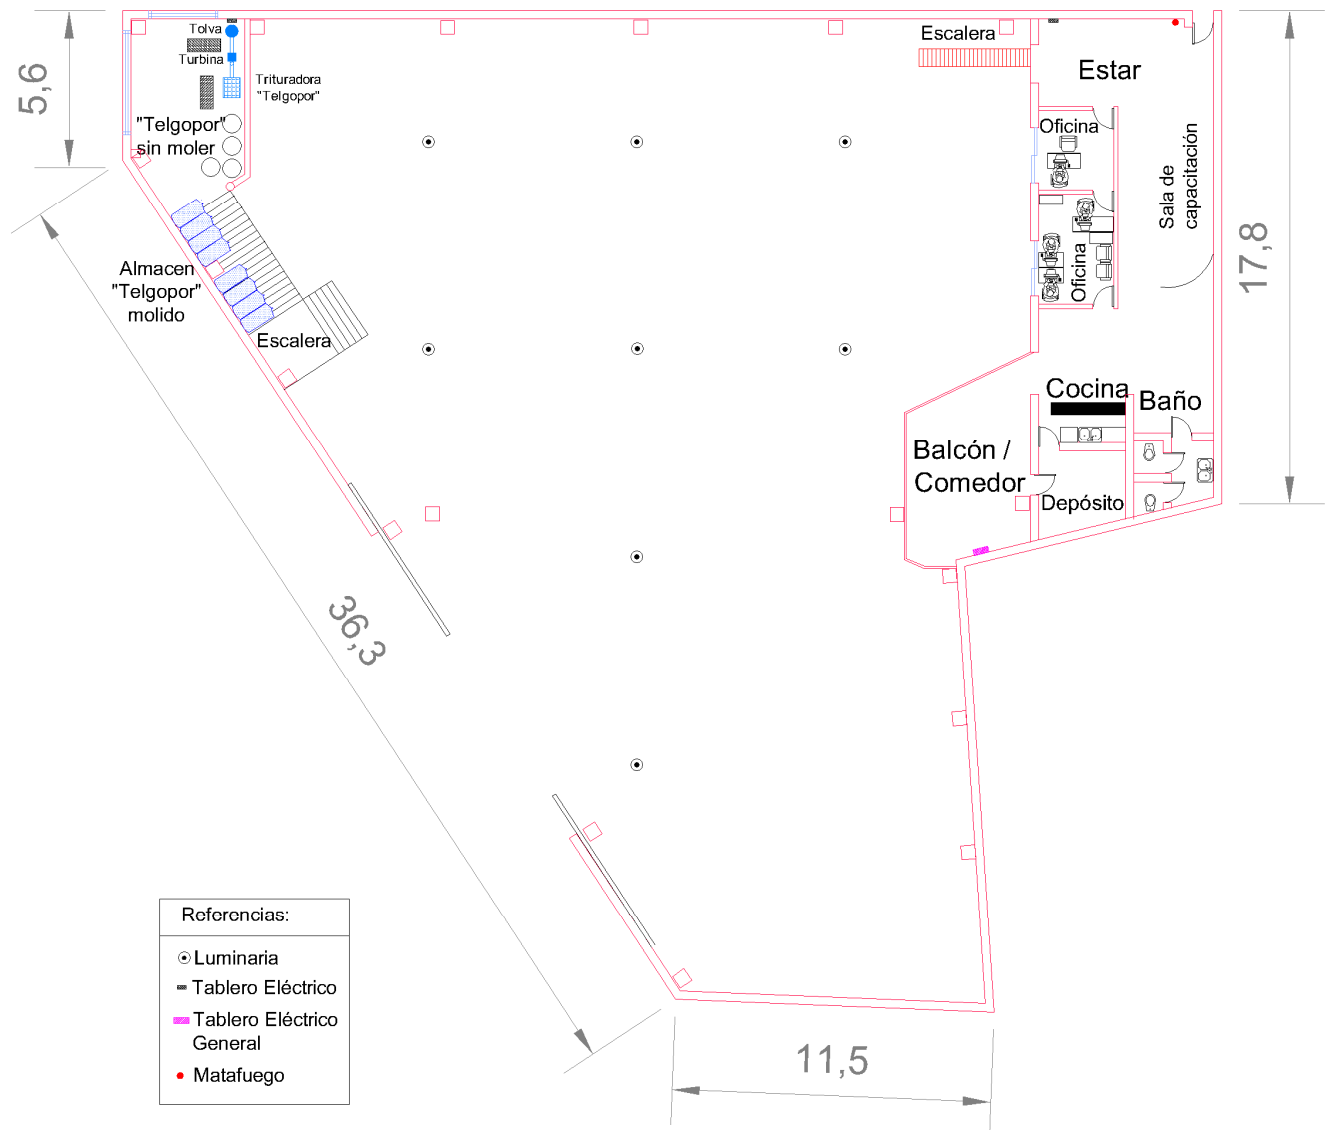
Lay Out Centro Verde Tillard planta alta.
